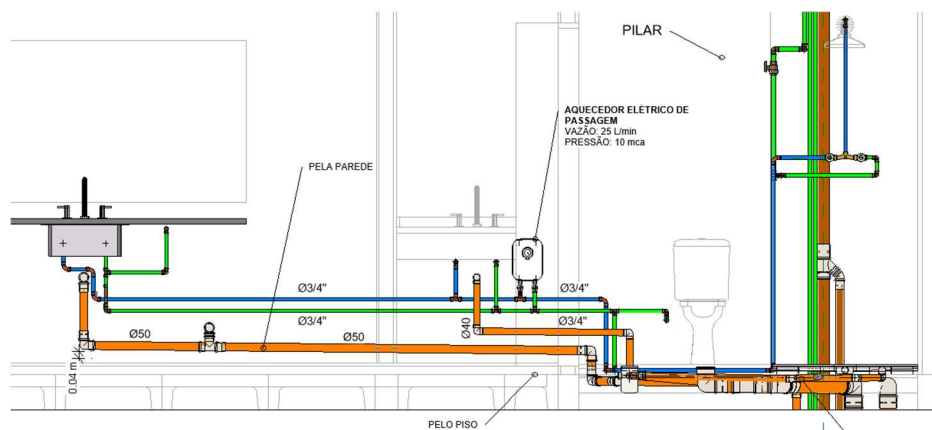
1º Pavimento – Corte transversal apartamento K.
